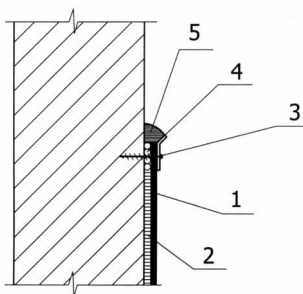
Примыкание кровли к парапету, стене с окончанием краевой рейкой
